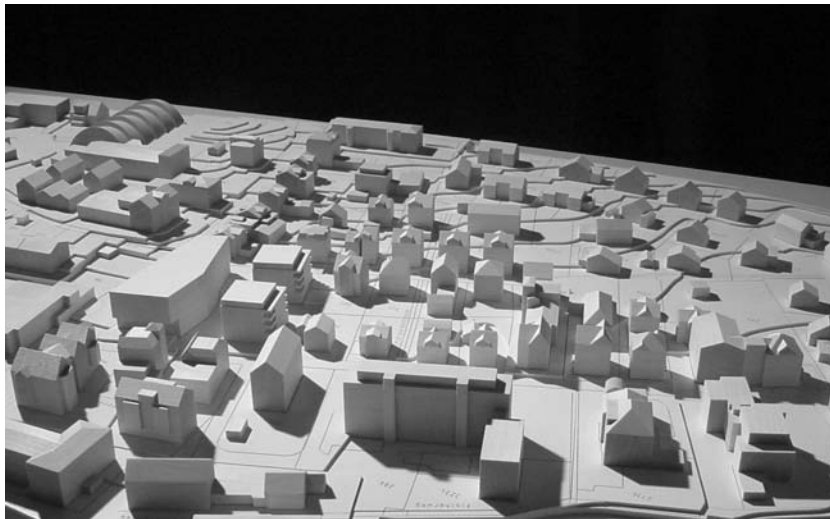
Modellansicht Nordwest mit bestehenden Bauten in der Umgebung
